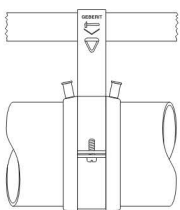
Fixpunkt F < DN 200 (ø 200) mit Elektroschweißband Art.-Nr. 36x.776.16.1
